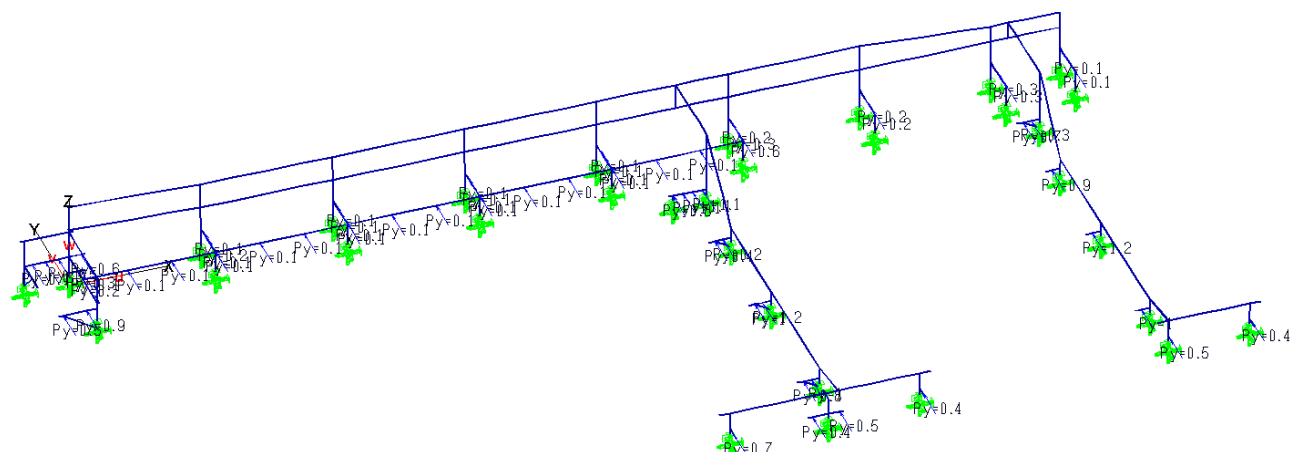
Горизонтальная нагрузка от трубопровода по оси Y
